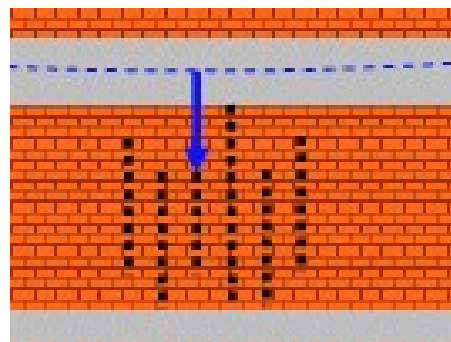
Fissuração vertical da alvenaria do pano inferior devido a flecha positiva (Araújo, 2003)
